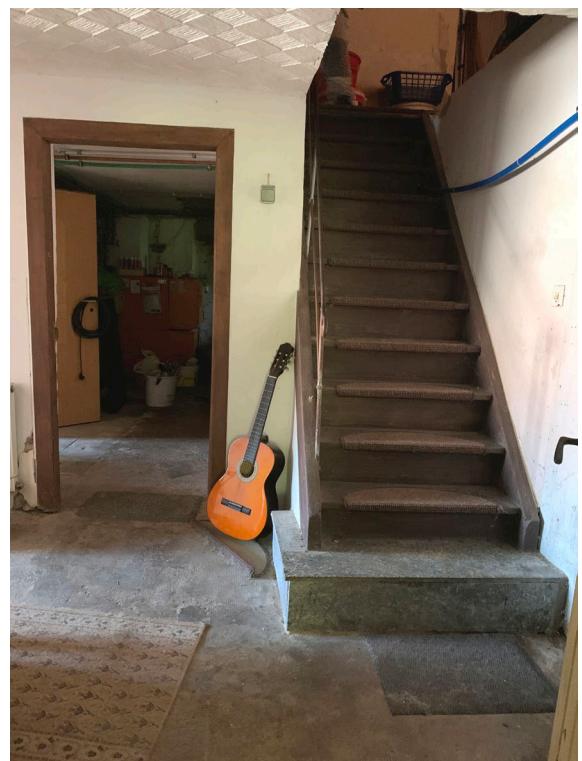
Kellergeschoß, Flur mit Treppe zum EG/OG
